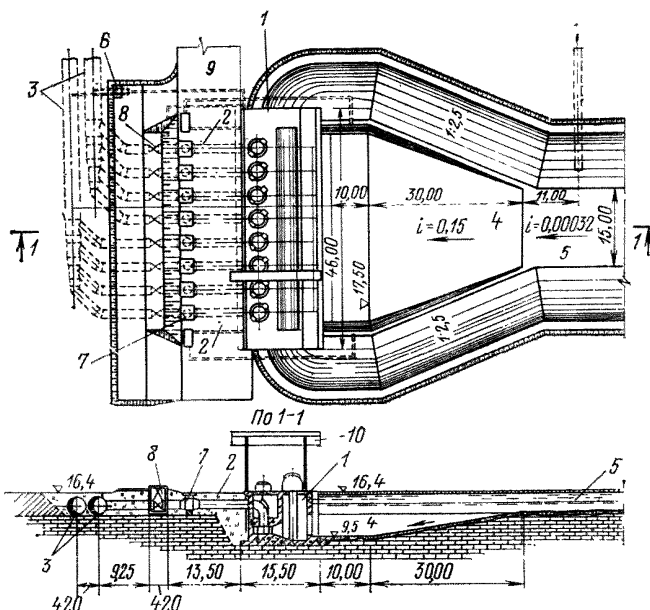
Расположение напорных трубопроводов при схеме технического водоснабжения с центральной насосной станцией. План и продольный разрез
